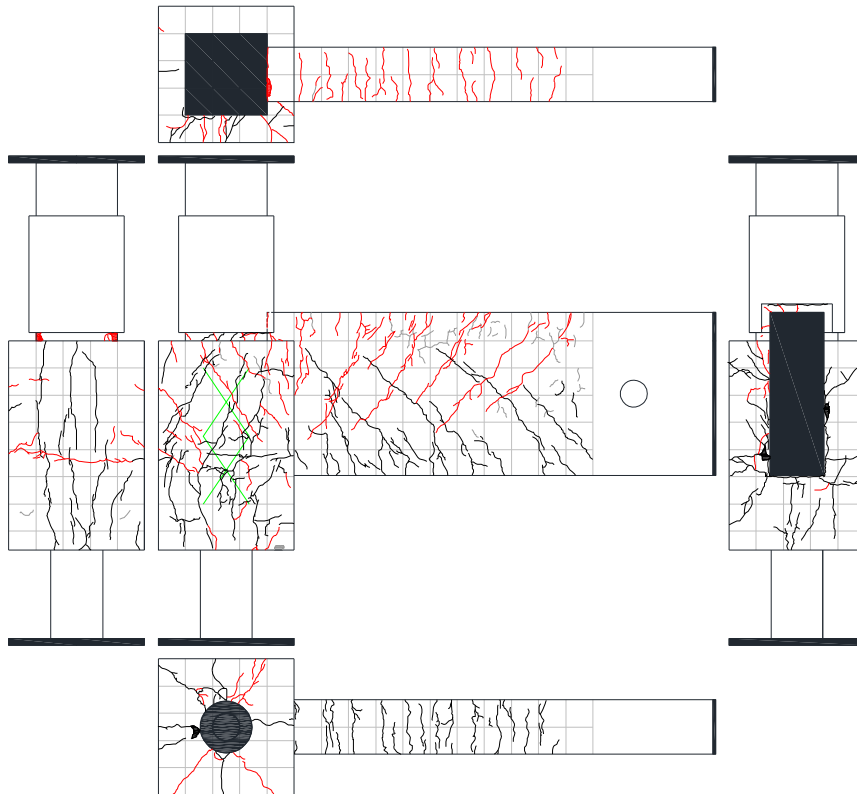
試験体 D-4 ひび割れ状況 (7Cycle)
